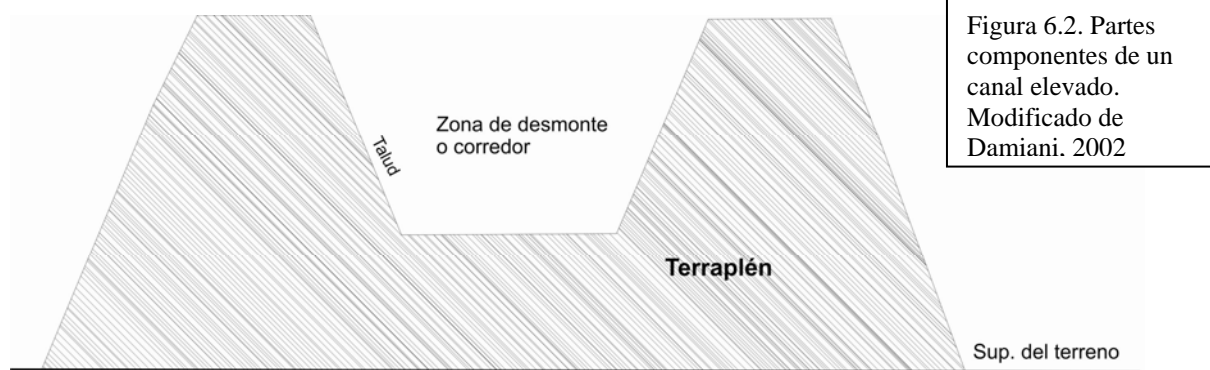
Partes componentes de un canal elevado. Modificado de Damiani. 2002
